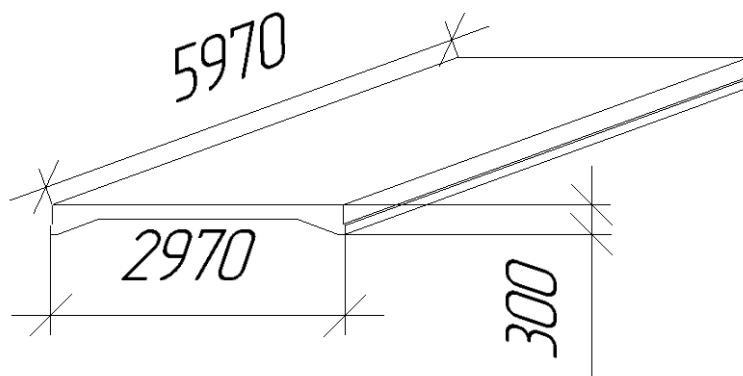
Залізобетонні плити покриття по серії ПК-01-74/62
